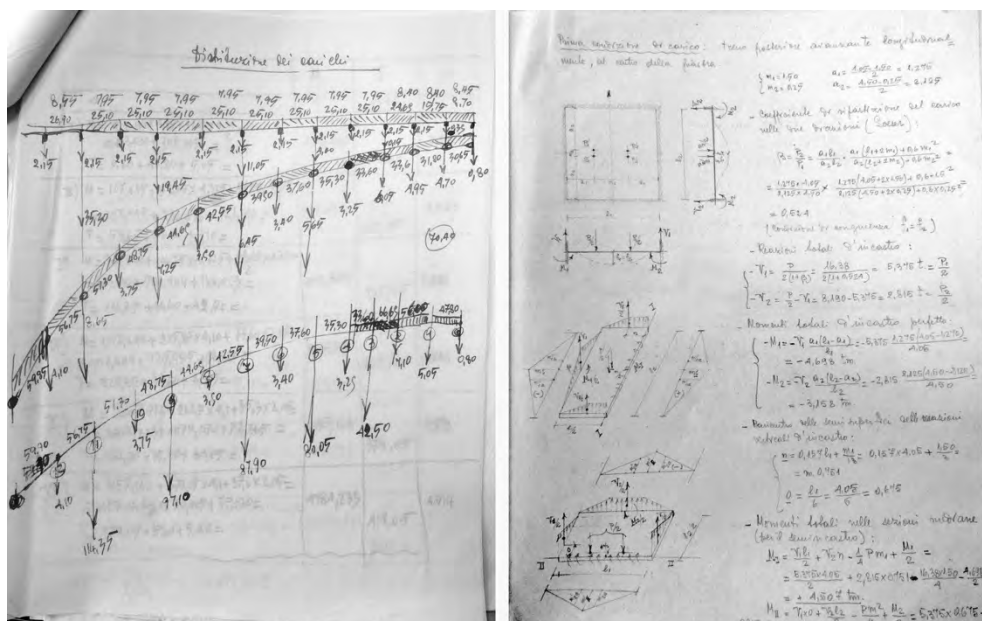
Ing. G. Cantamaglia: ponte di Salle, schizzi e calcoli di alcune parti della struttura in calcestruzzo armato.
